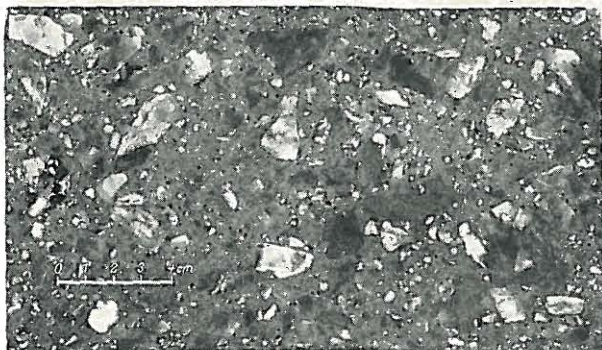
Schnitt durch den Barytbeton des Kernreaktors Geesthacht
